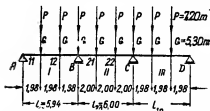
Расчетная схема главной балки и расчетные нагрузки.
